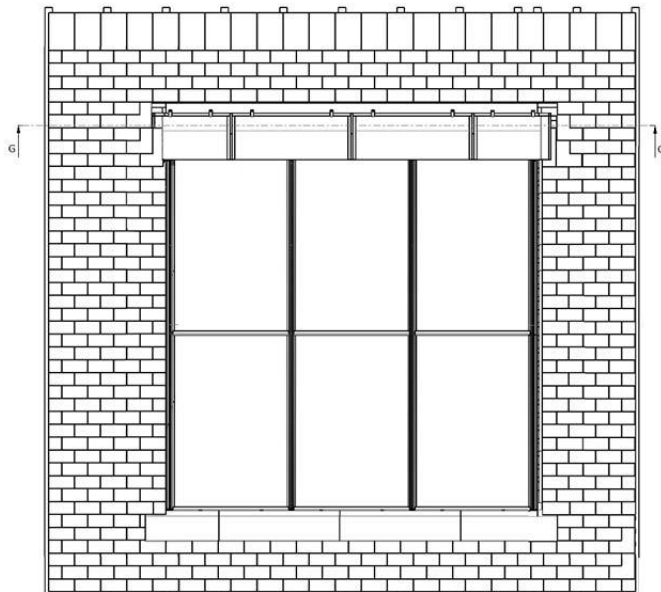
Pose de l'abergement supérieur droit pour installation sur toiture ardoise
